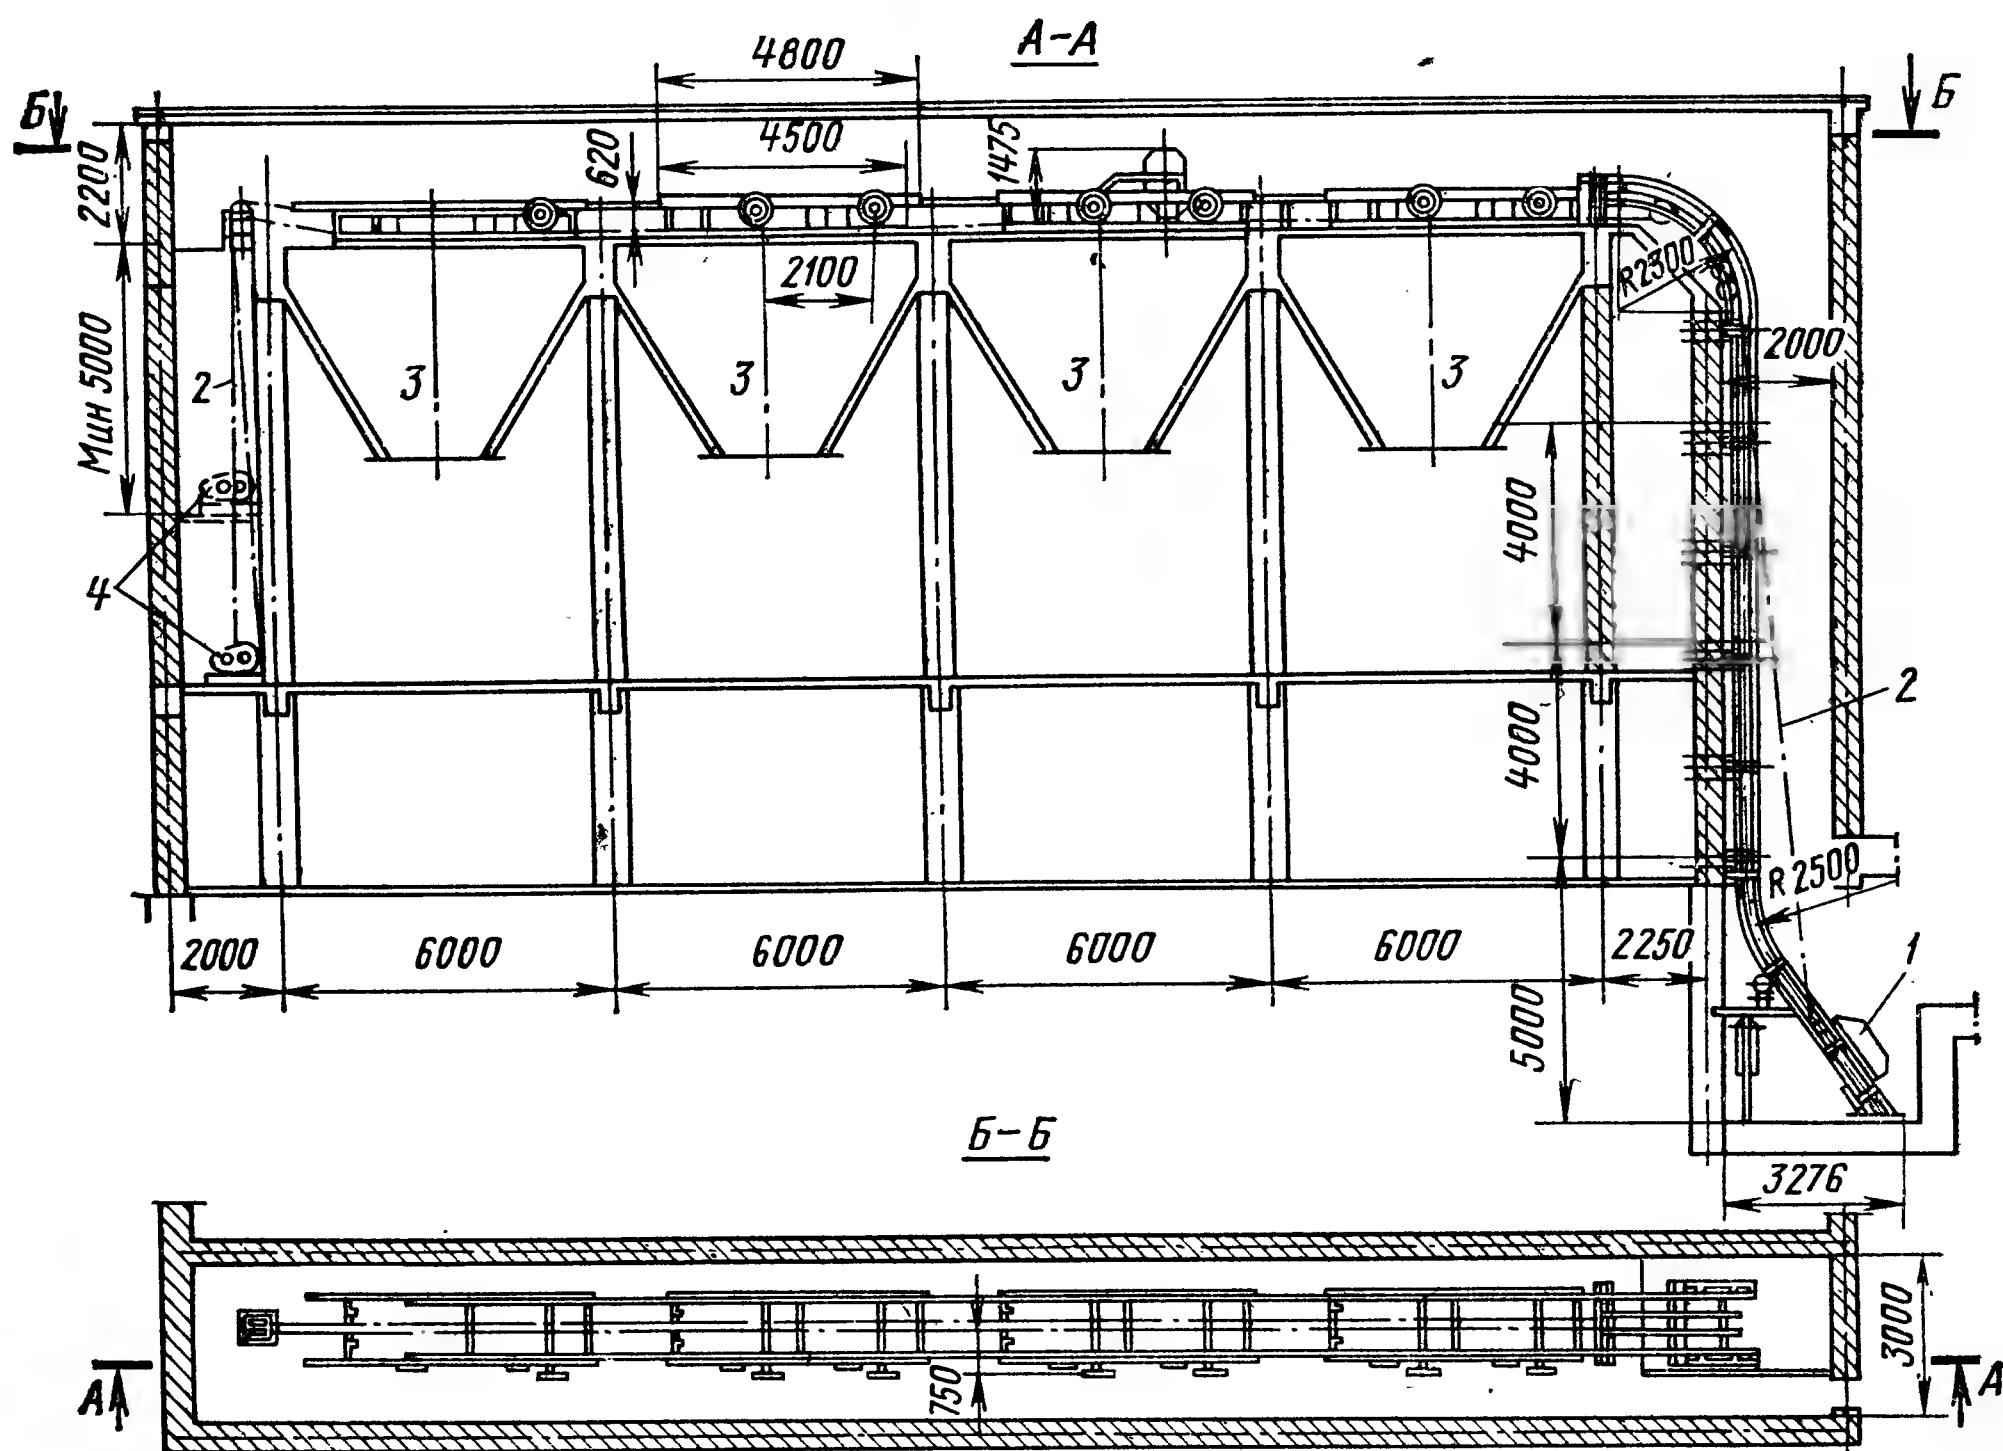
Топливоподача с дробилкой и подъемником Шевьева.
